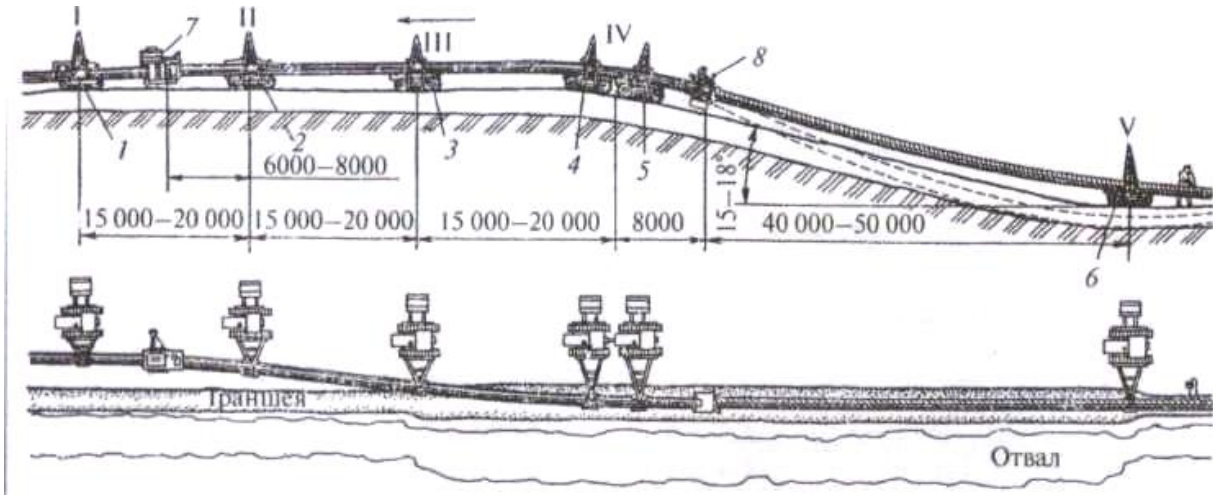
Производство изоляционно-укладочных работ совмещённым способом на продольном уклоне:
